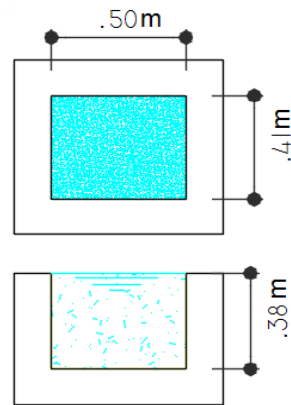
Vista en planta y perfil del tanque donde se realizó el aforo.
